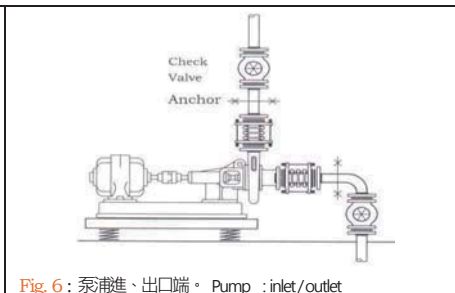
泵浦進、出口端。 Pump : inlet/outlet
